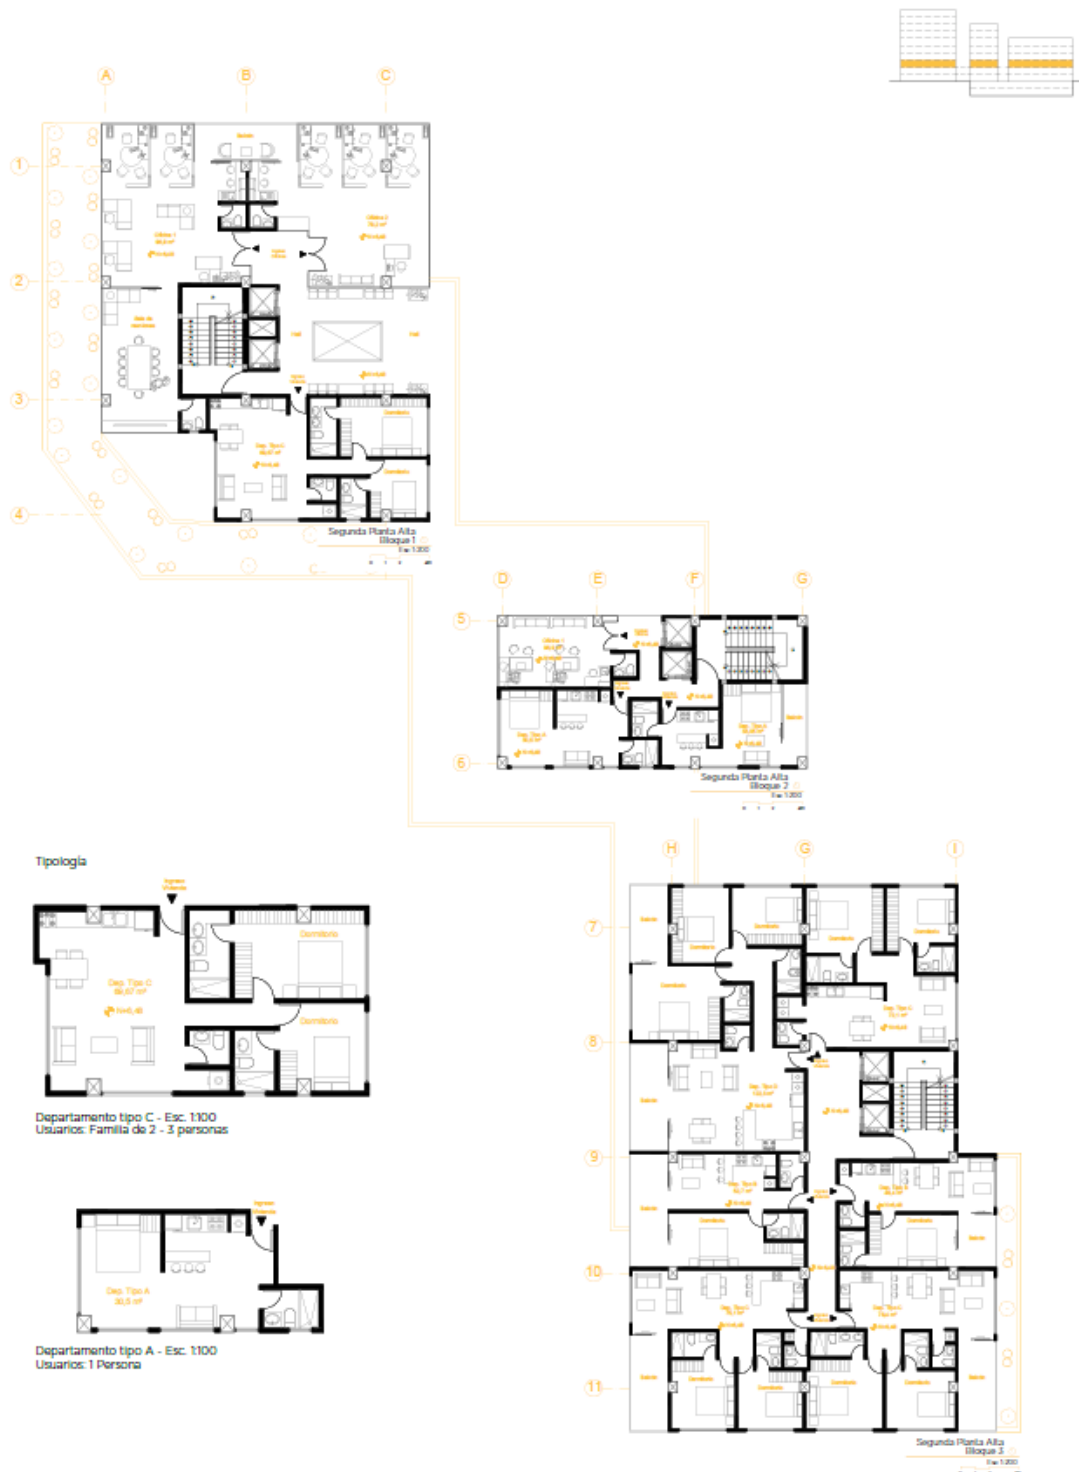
Planta de viviendas Fuente: Memoria gráfica - Elaboración Propia
